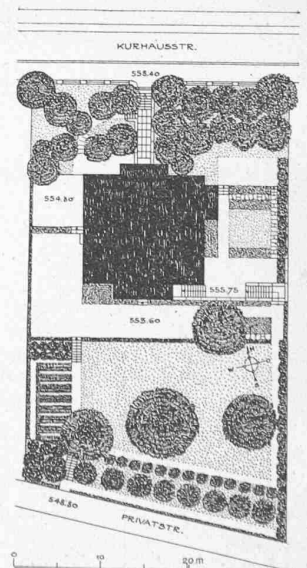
Lageplan des Hauses Kurhausstrasse 44. — 1 : 800.
